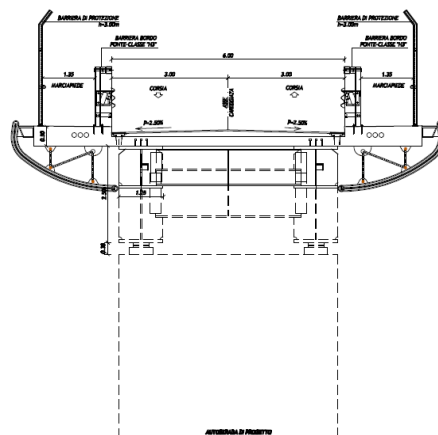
SEZIONE TIPO IMPALCATO CAVALCAVIA DI STRADA COMUNALE
